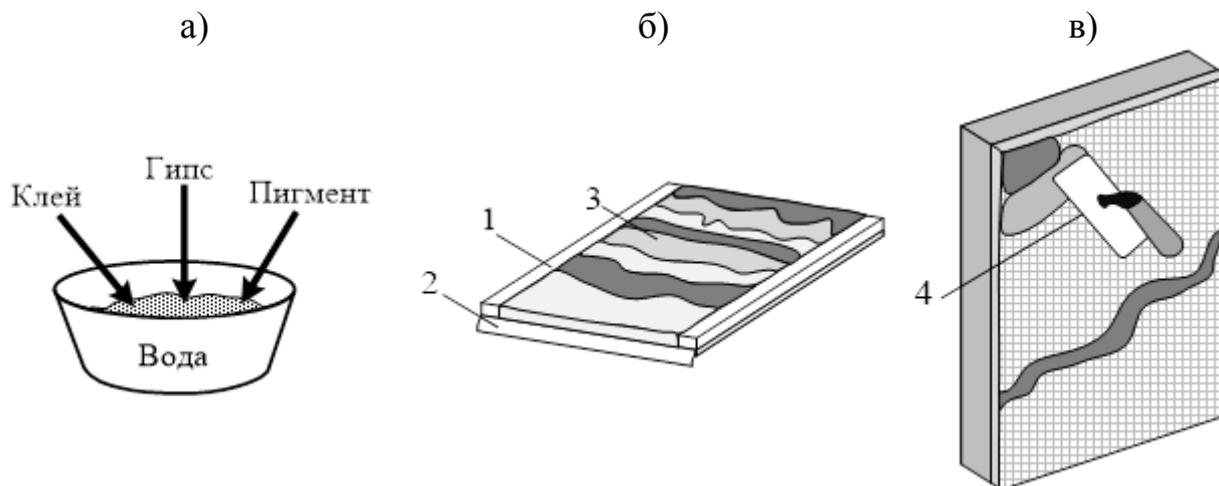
Приготовление (а), подготовка (б) и нанесение (в) гипсового теста в лопаточном способе: 1 – щит; 2 – мешковина; 3 – цветные слои; 4 – кельма
